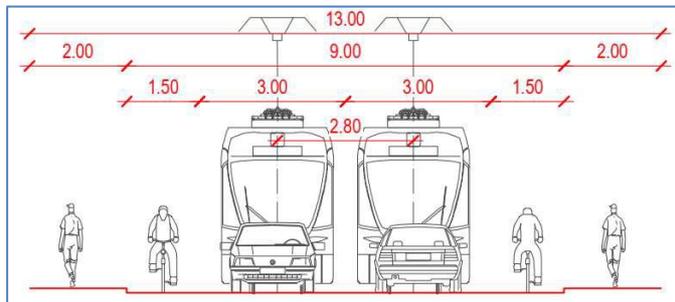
Schemaquerschnitt Abschnitt Dorfkern
